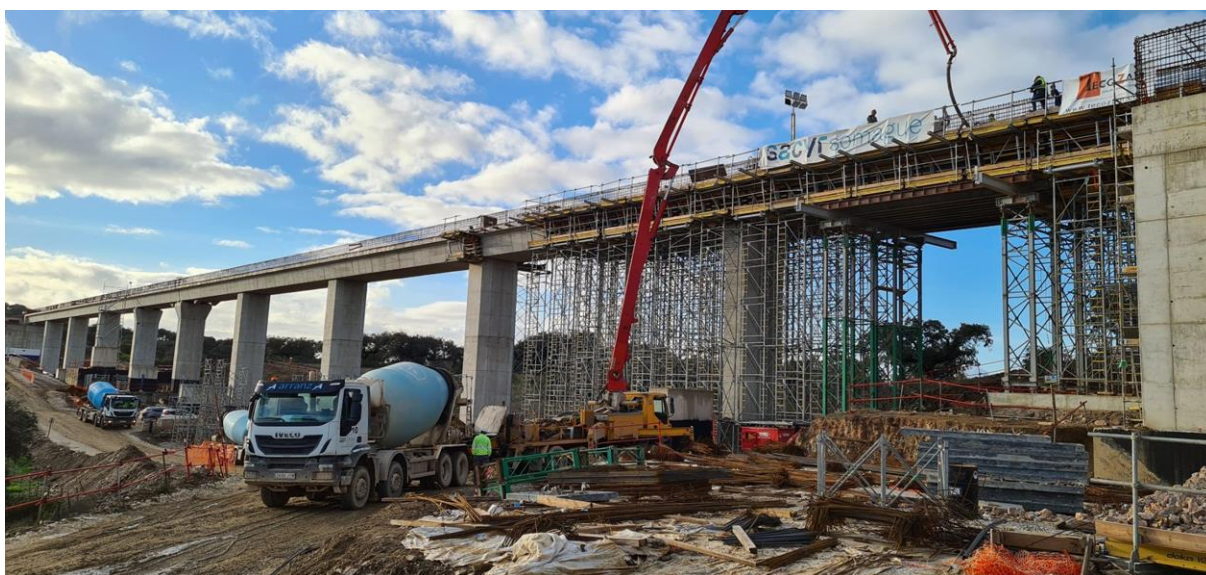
Viaduto da Asseca – Betonagem do Último Tramo do Tabuleiro com Cimbre ao Solo.
